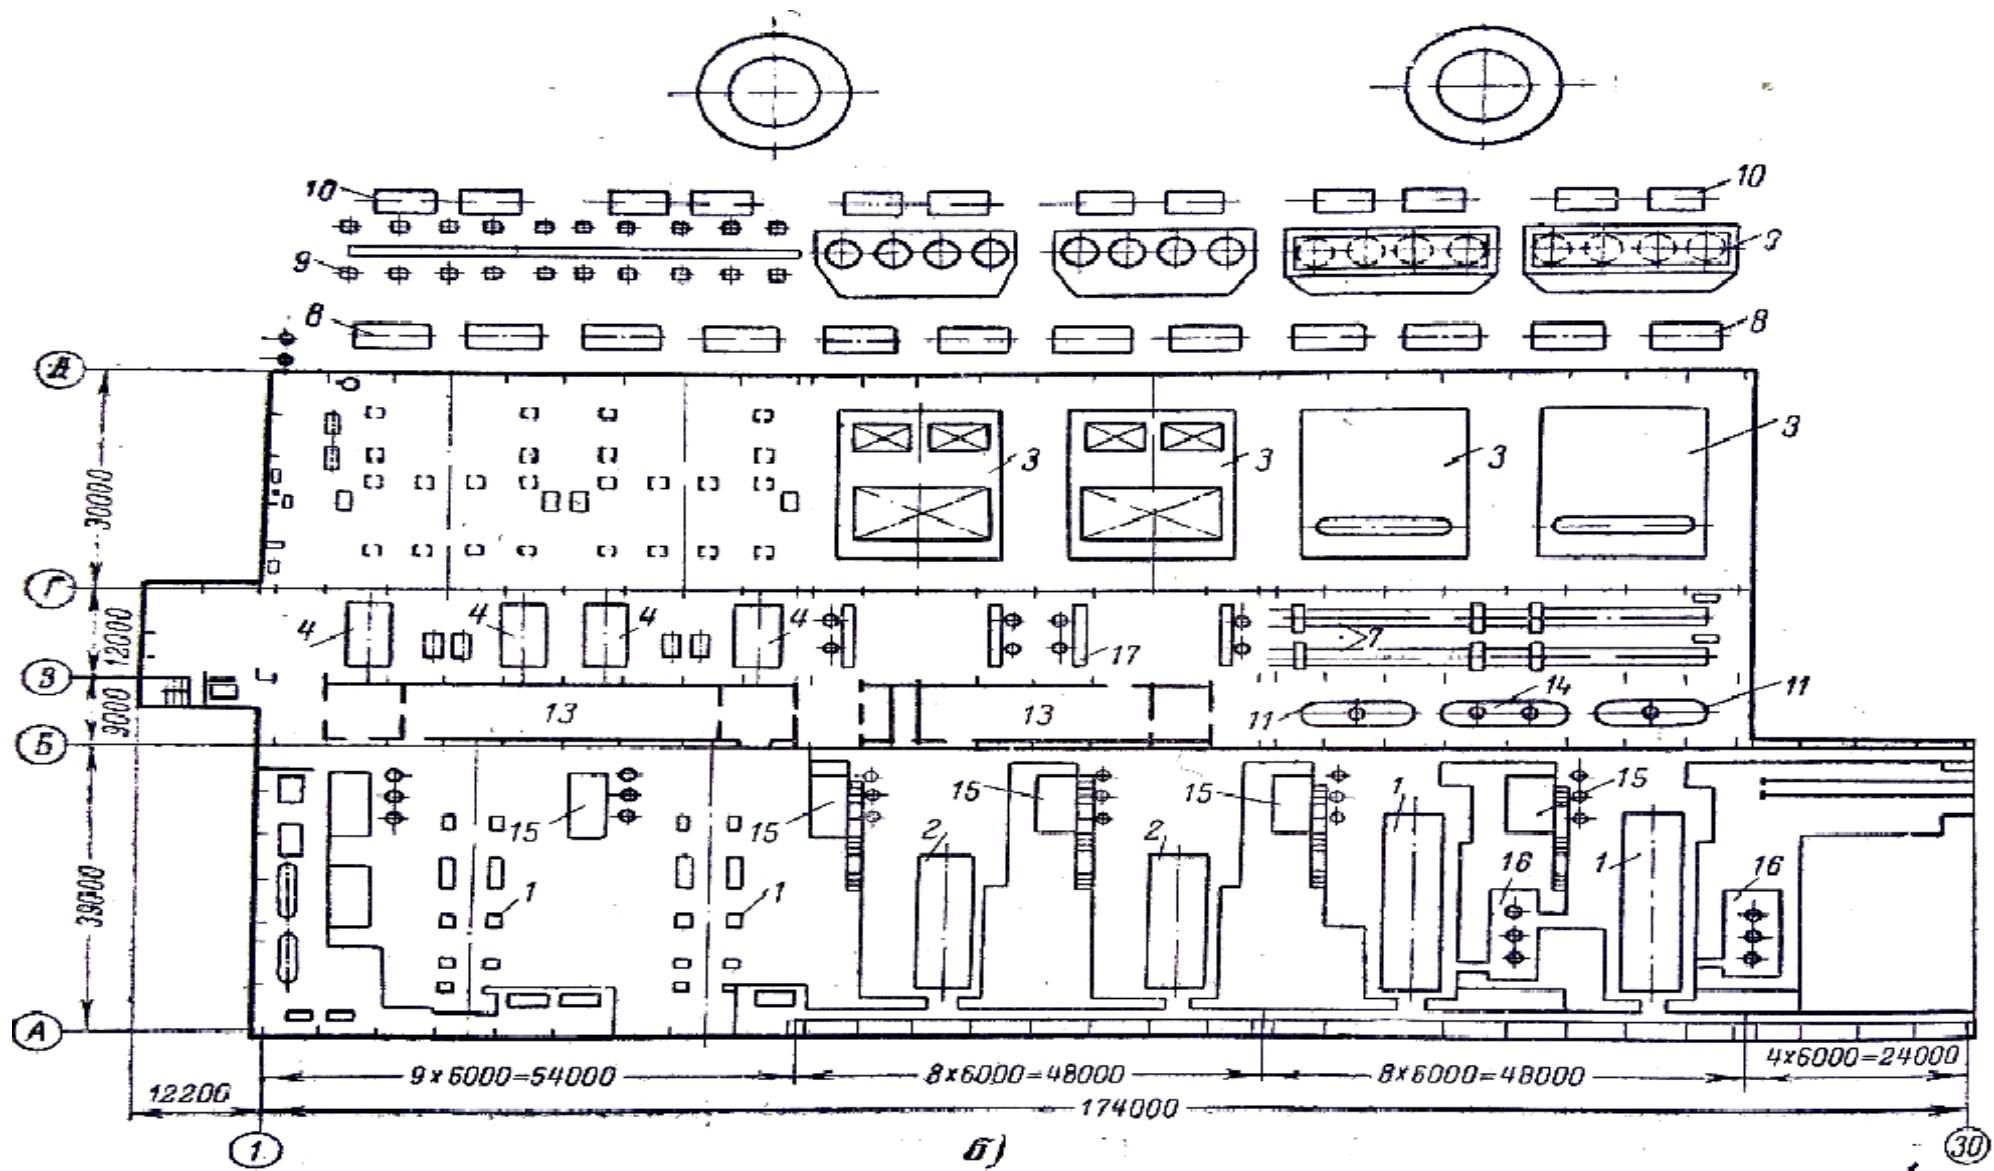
Компоновка главного корпуса пылеугольной ТЭЦ.
